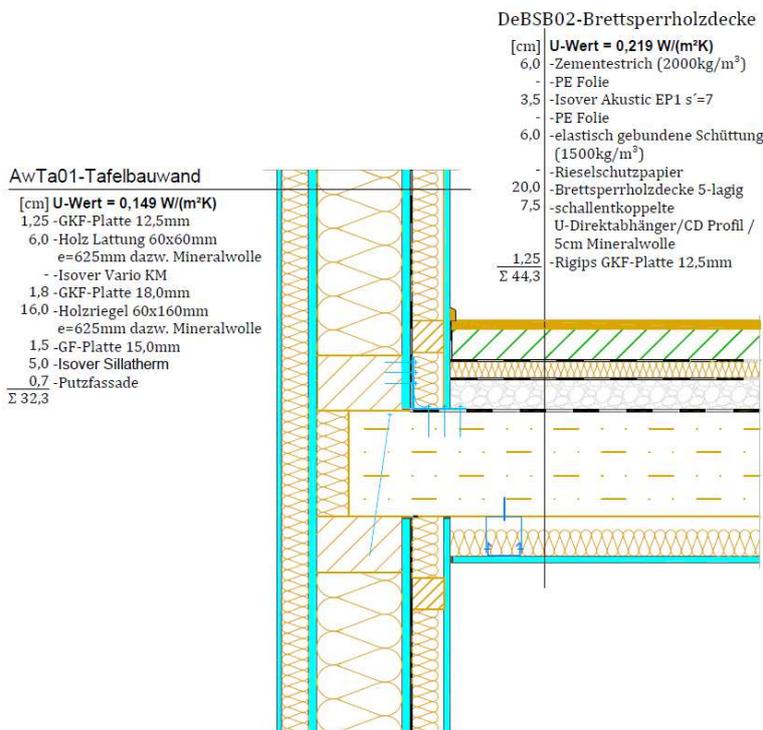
Anschlussdetail der nichttragenden Außenwand mit einer BSP-Decke
